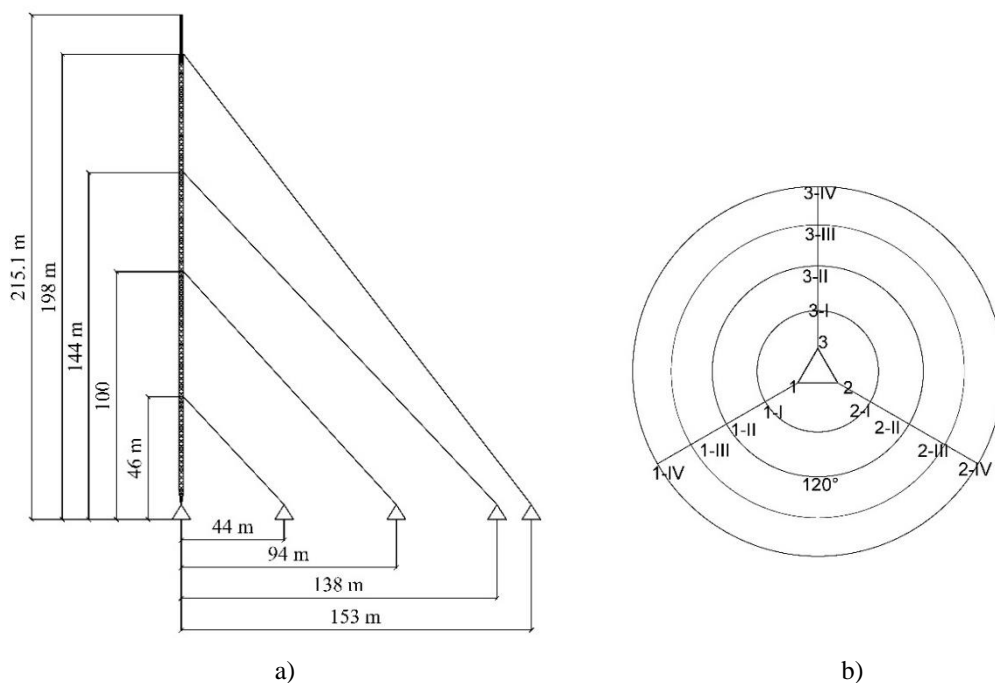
Torre Santa Clara. a) Elevación de la torre b) Disposición de los cables
